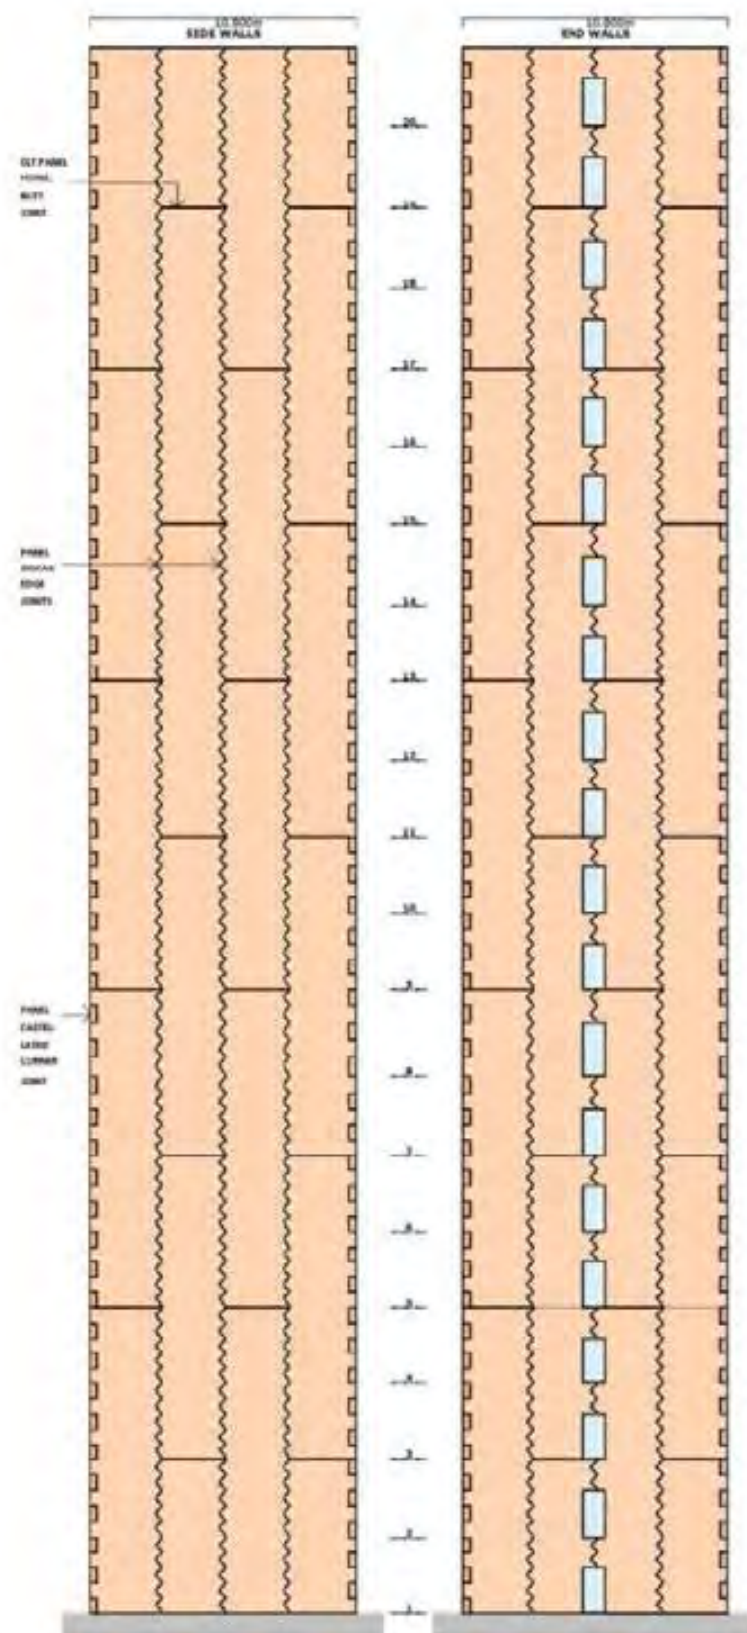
Prospetto del nucleo centrale. Immagine tratta da "Integrating cross-laminated timber panels to construct buildings to twenty levels" John Chapman.
